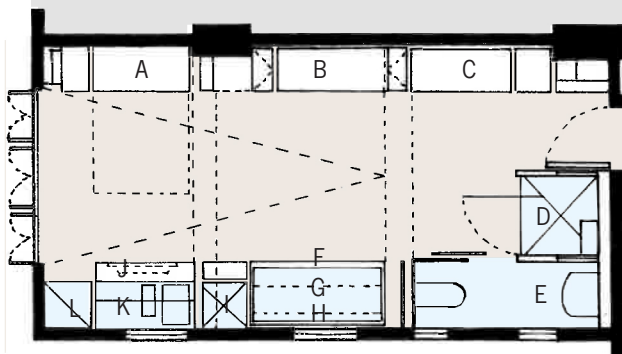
Planta do apartamento em 1976. Esc. 1:100.
